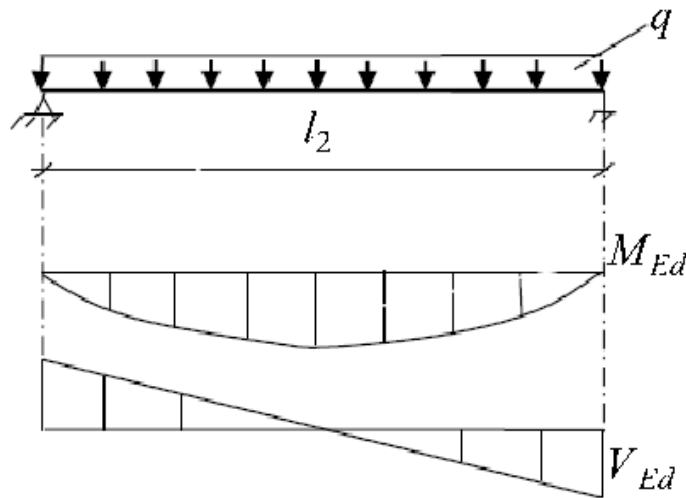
Расчетная схема балки (однопролетная разрезная балка)
